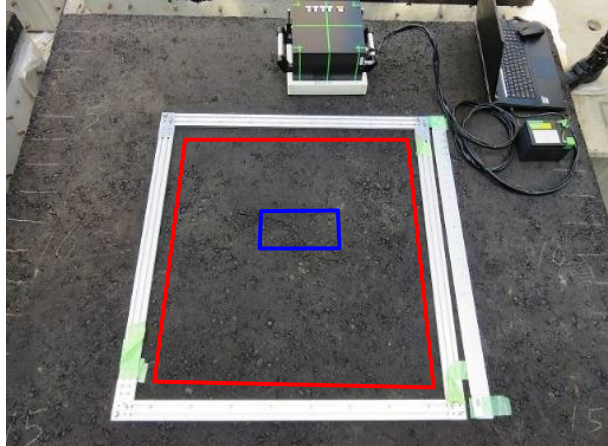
アスファルトを舗装した模型供試体 No.2 (ひび割れ)
